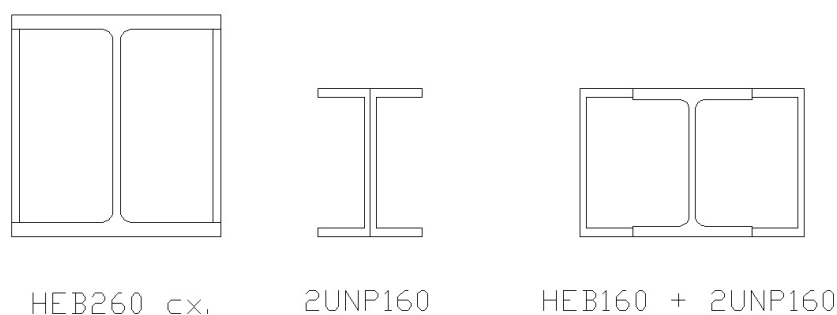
Secção transversal de alguns elementos da viga principal.
